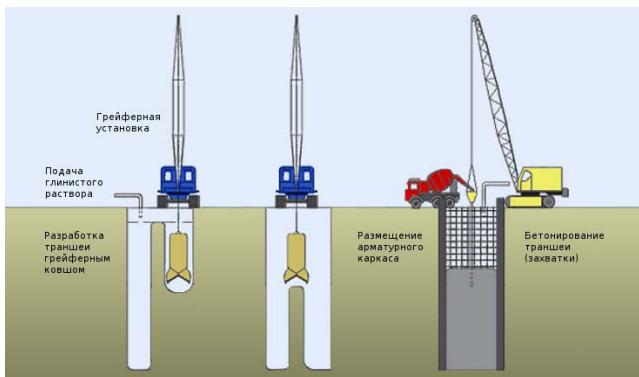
Технология изготовления стен и фундаментов, возводимых способом «стена в грунте»
